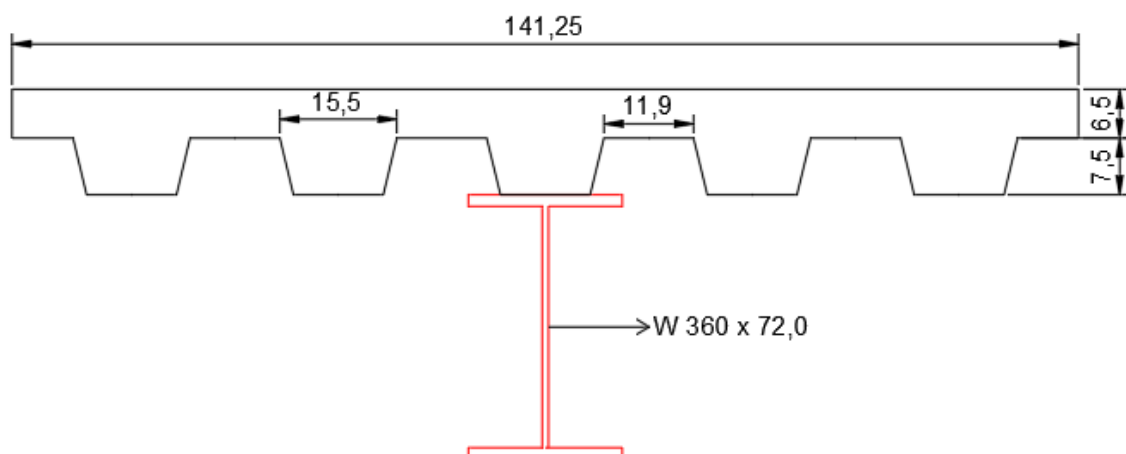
Seção transversal da viga mista de 5,65 metros.
